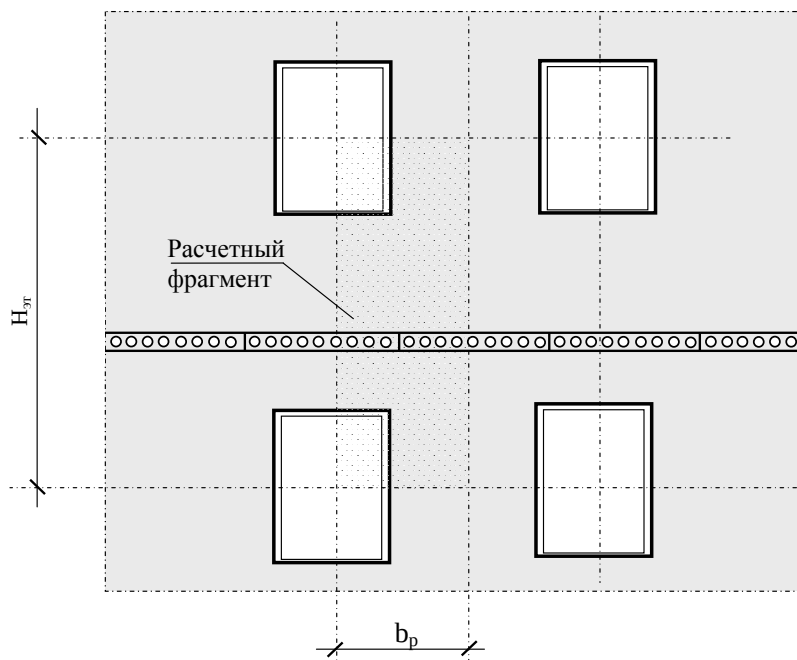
Расчетный фрагмент наружной стены здания для определения приведенного сопротивления теплопередаче участка с оконными проемами (вид со стороны помещения)
